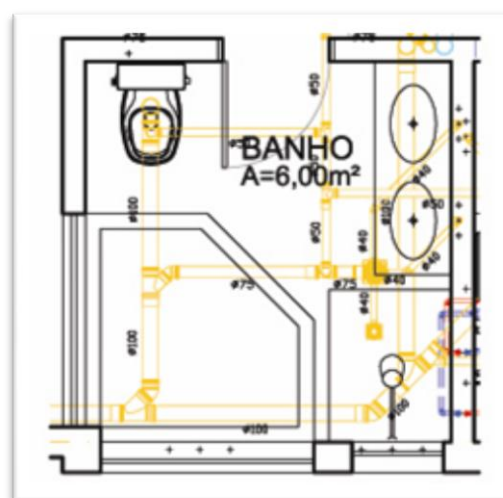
Planta baixa do desalinhamento dos aparelhos e intersecção com esquadria.
